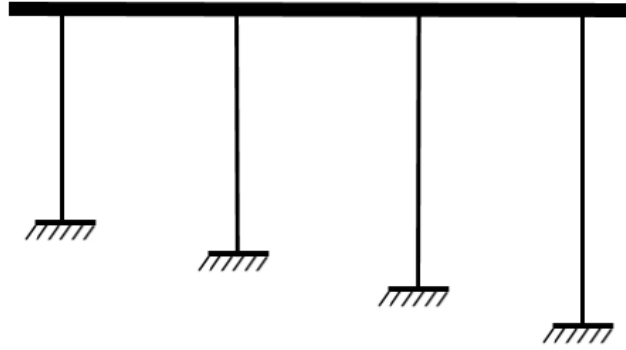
Modelo estructural - Sitio 3 del puerto de Valparaíso.
